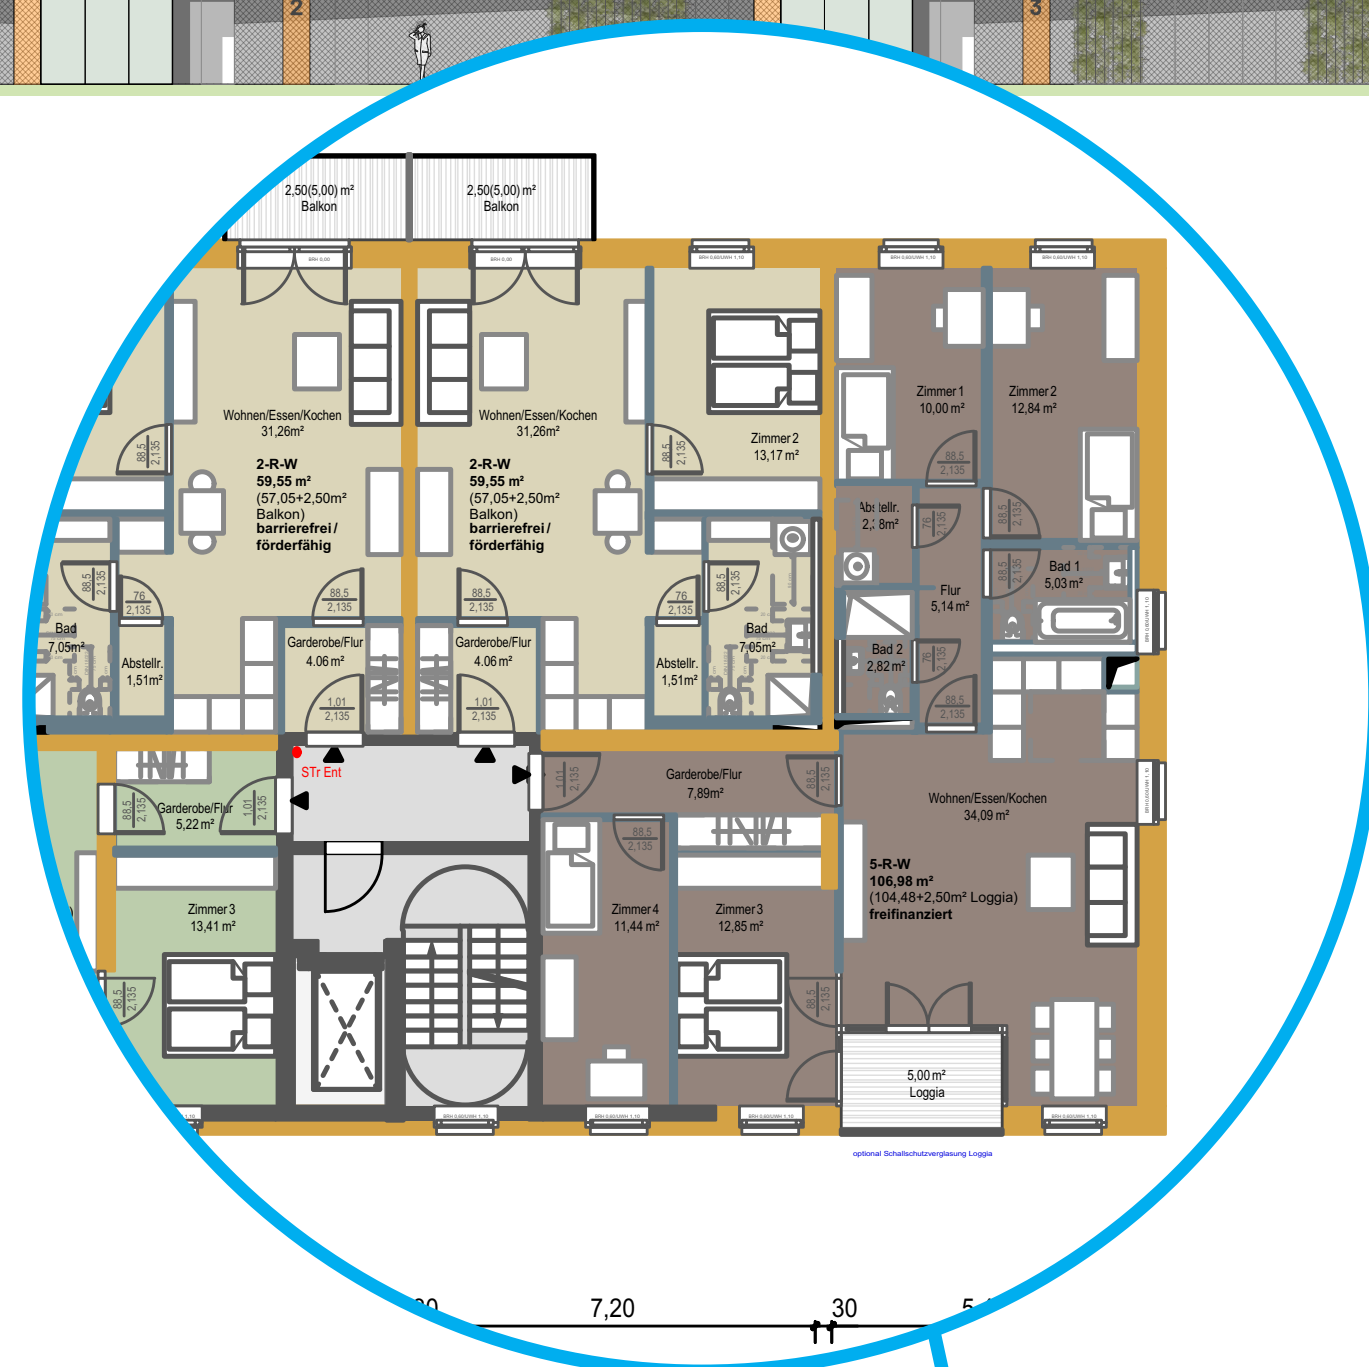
Wohnungsgrundrisse, Regelgeschoss
